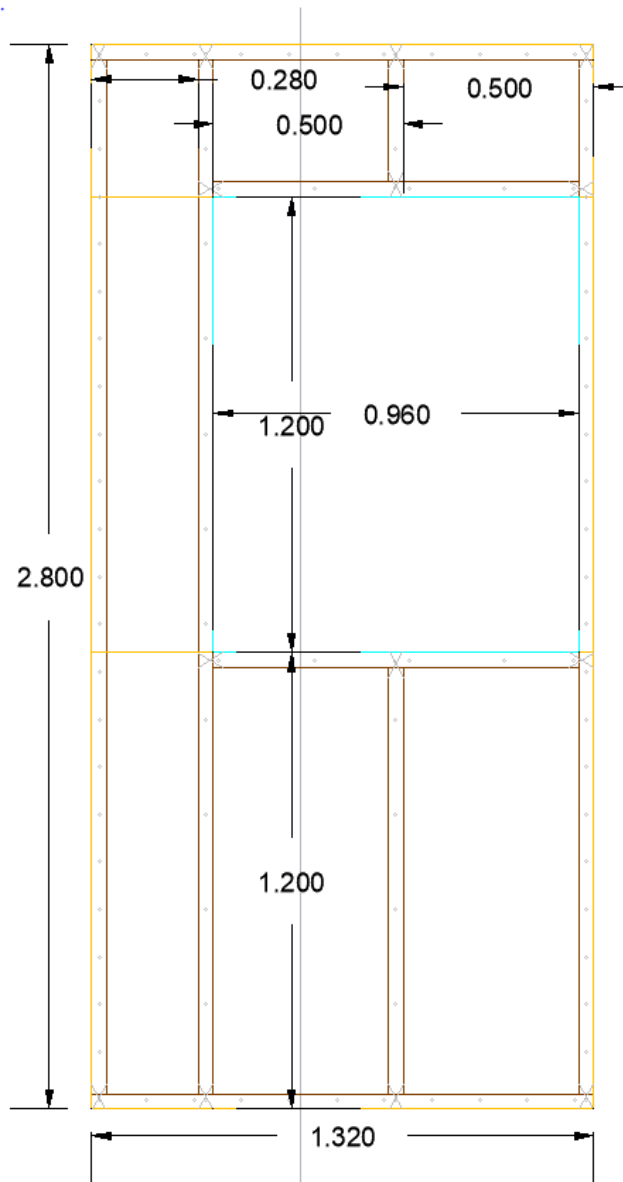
, Muro no estructural M5 1.32 x 2.8
